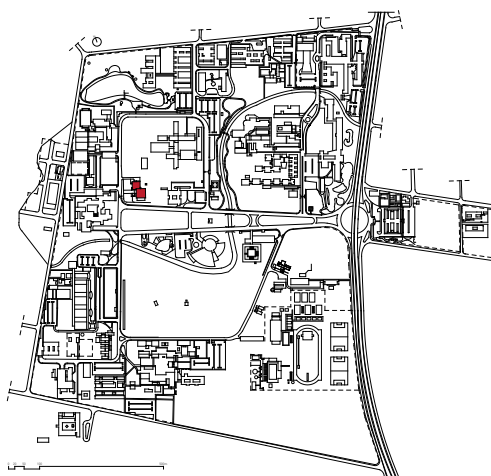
Planta de Situação com destaque ao Restaurante.
